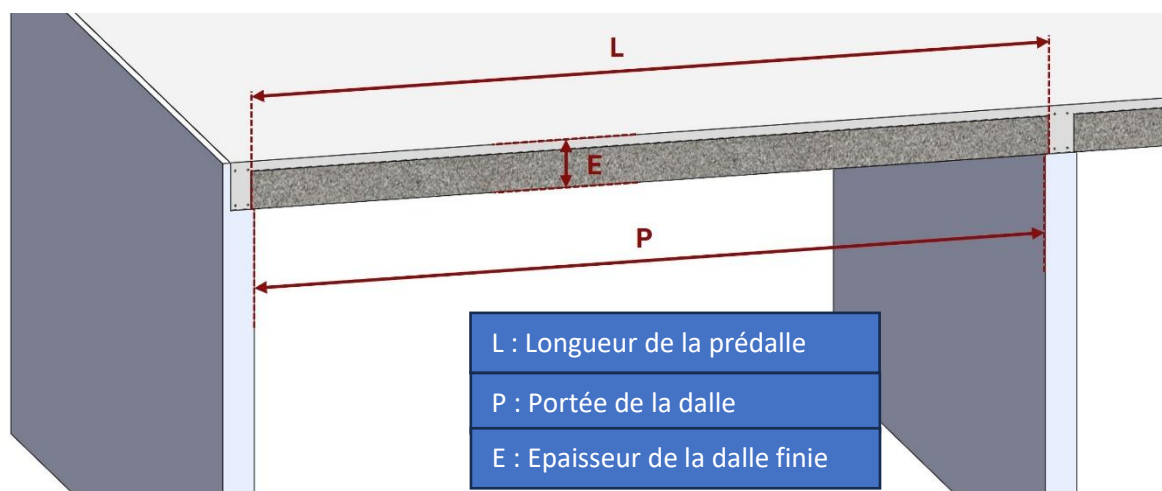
Représentation générale d'une dalle nervurée béton DS1
